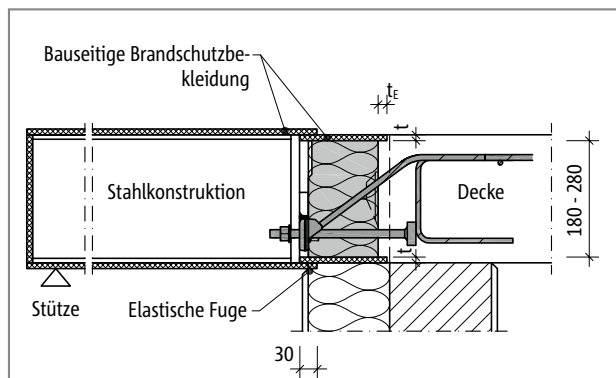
Schöck Isokorb® XT Typ SQ: Bauseitige Brandschutzbekleidung für den Isokorb® und Stahlkonstruktion; Schnitt
